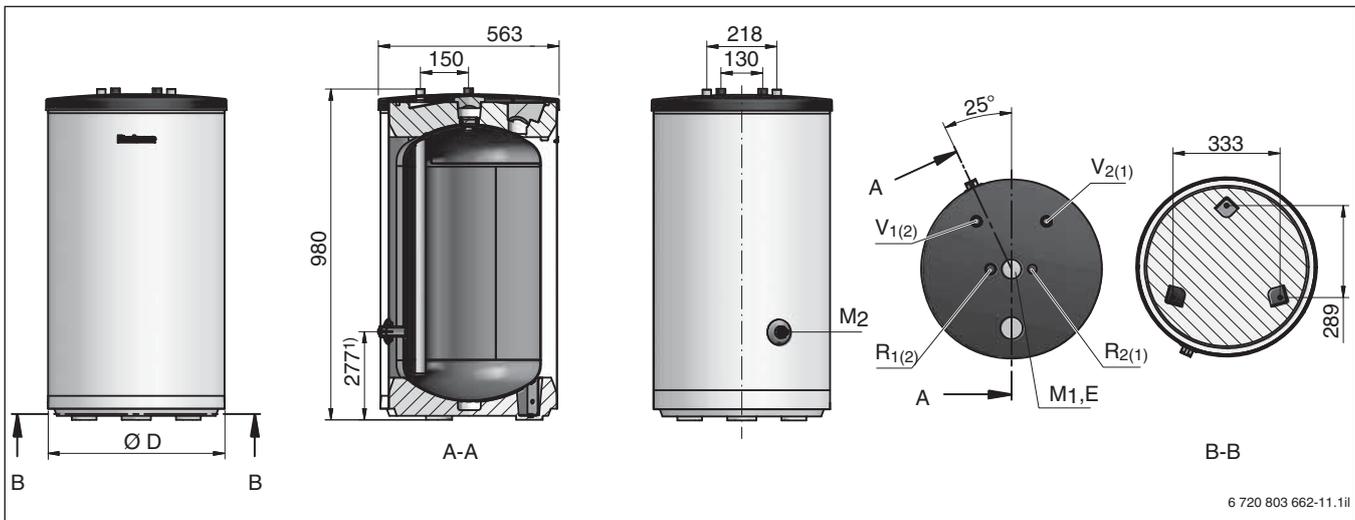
Anschlüsse Pufferspeicher P120/5 W (Maße in mm)
